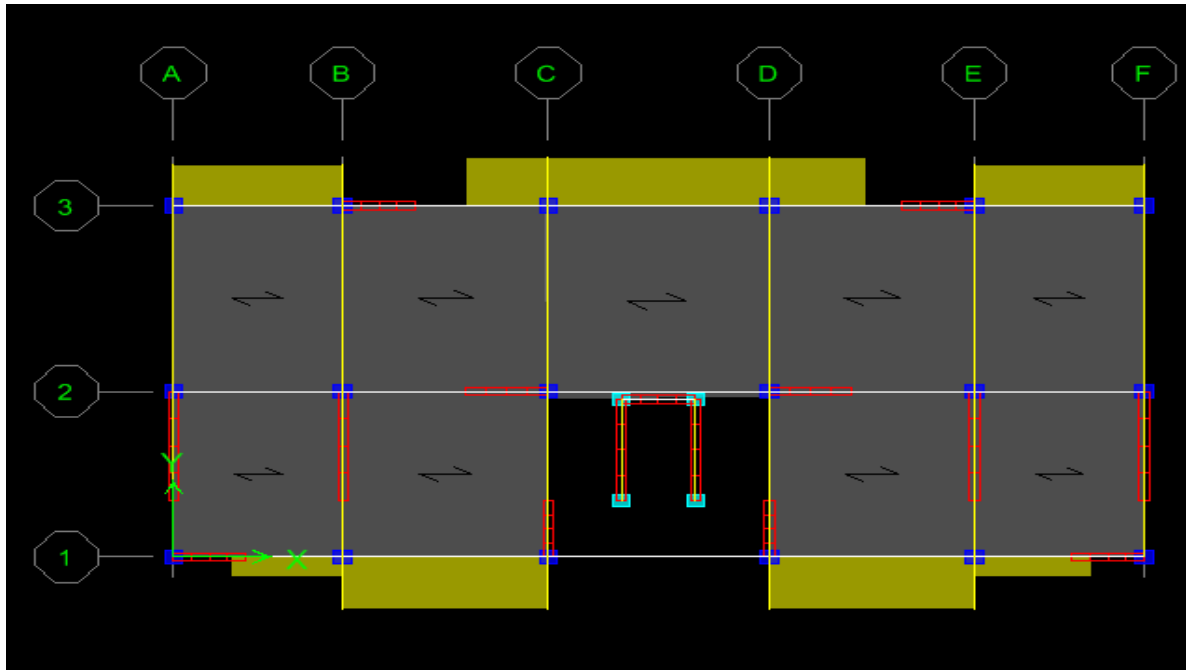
Disposition des voiles et poteaux –vue en plan.
